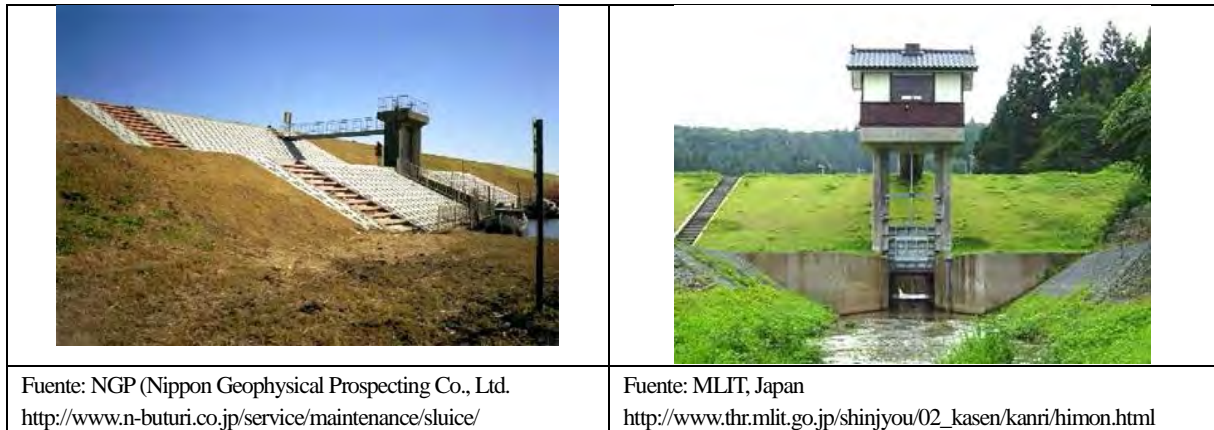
Ejemplo de esclusas en el Japón (para el Drenaje)
